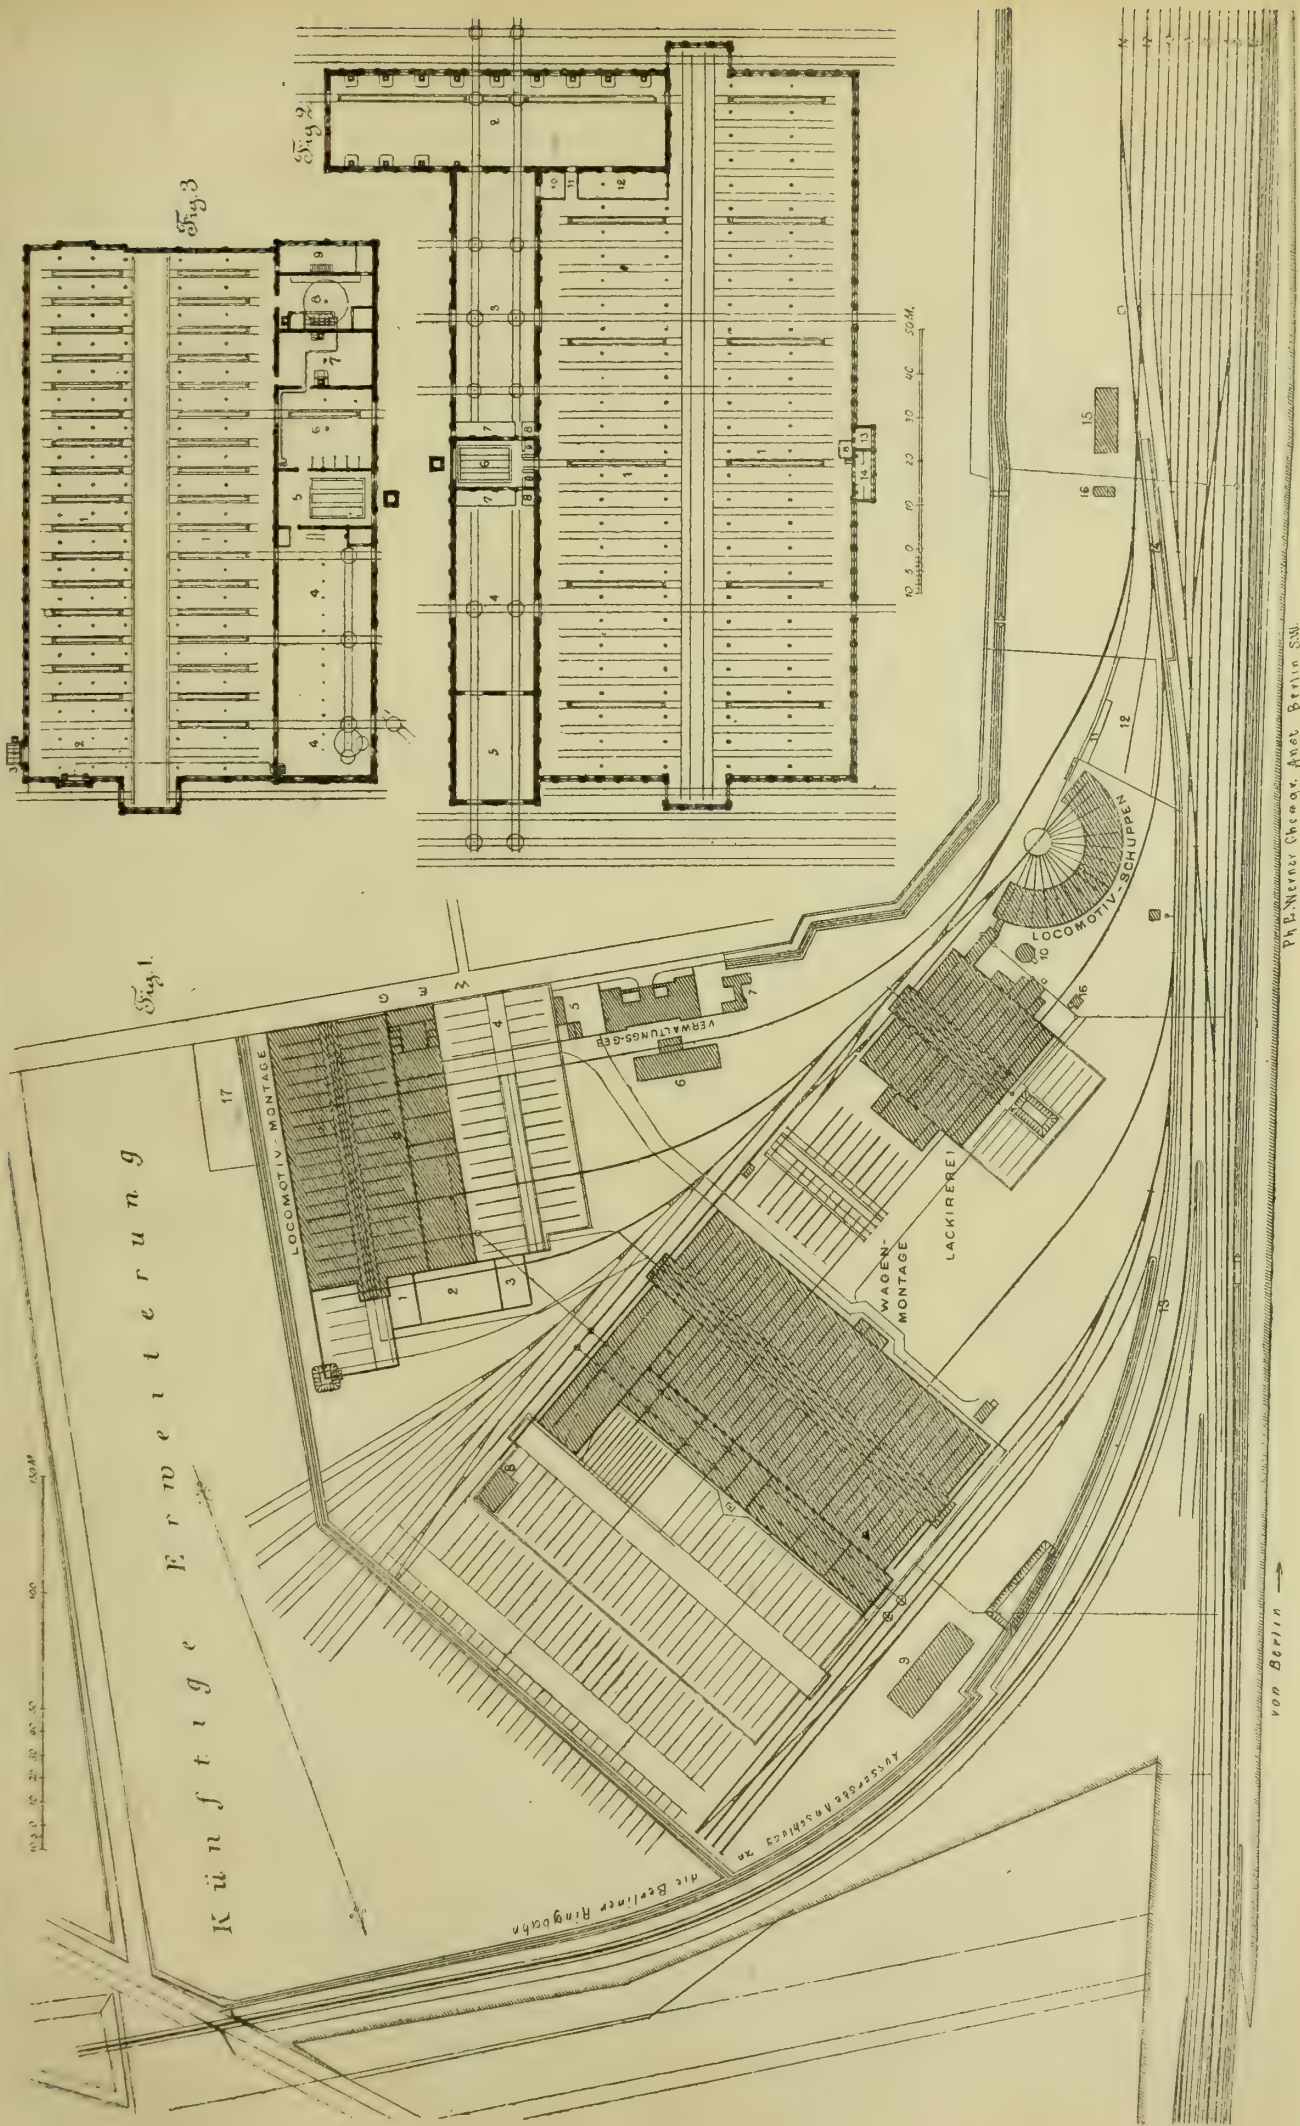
Grundriss der Wagen-Reparatur.
